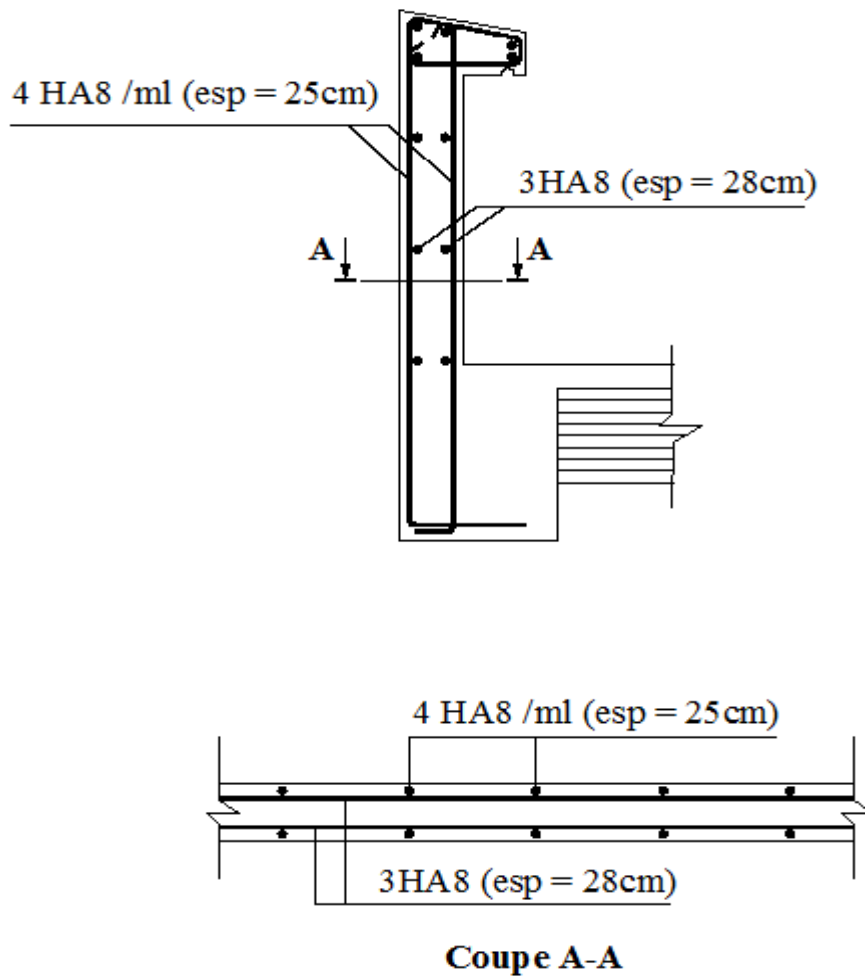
Plan de ferrailage de l'acrotère.
